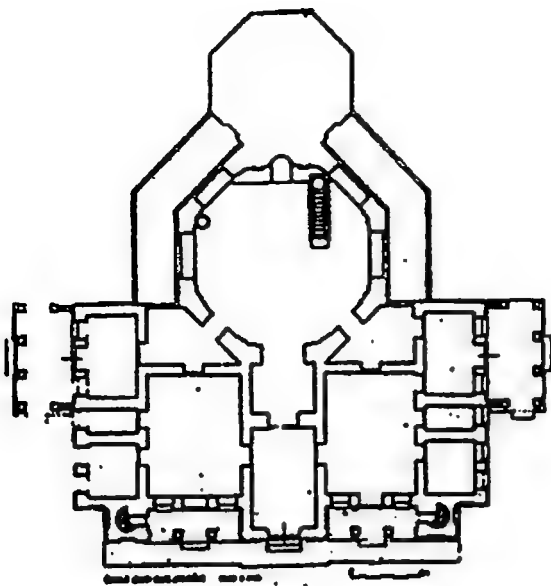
المسقط الأفقي لجامع لاله لي .
